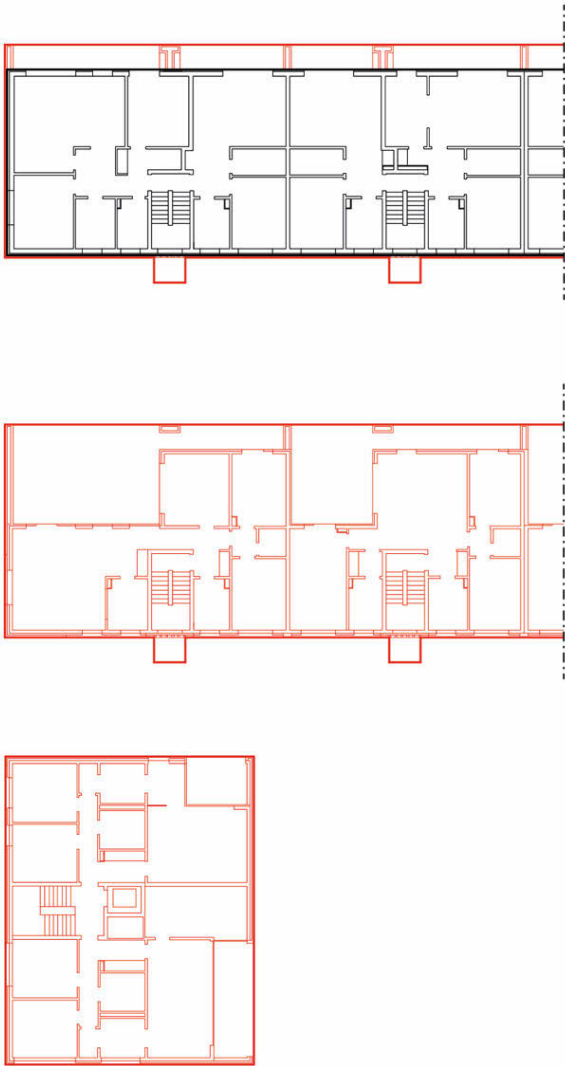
Grundrisse & Schnitt Bestand – Aufstockung 1, Altenhagener Weg
